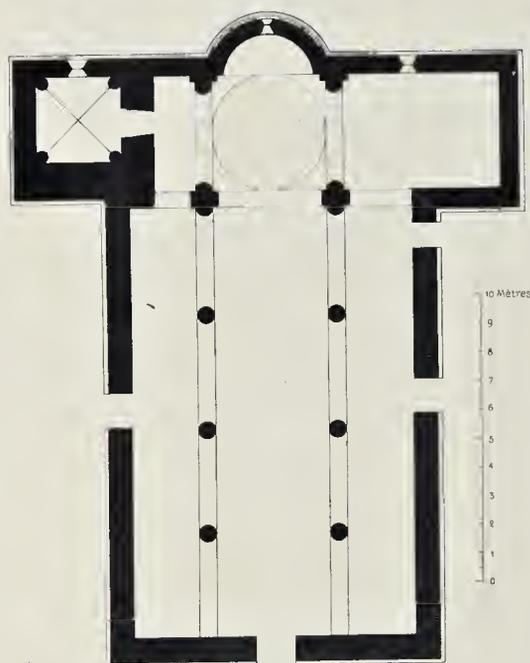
PLAN DE L'ÉGLISE SAN BASILIO, A TROJA.
